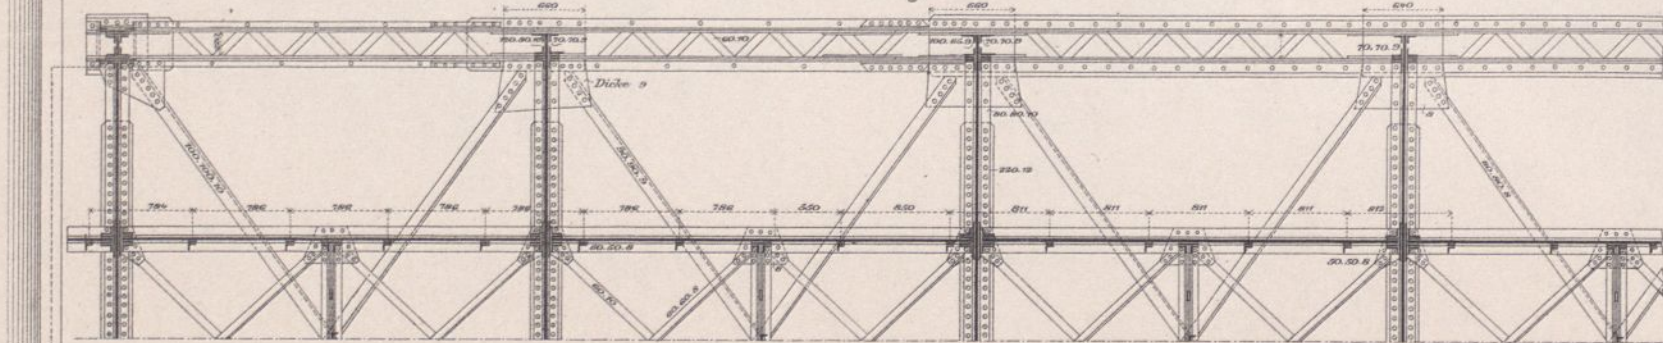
Grundriss. Obere Gurtung. 1:60.
